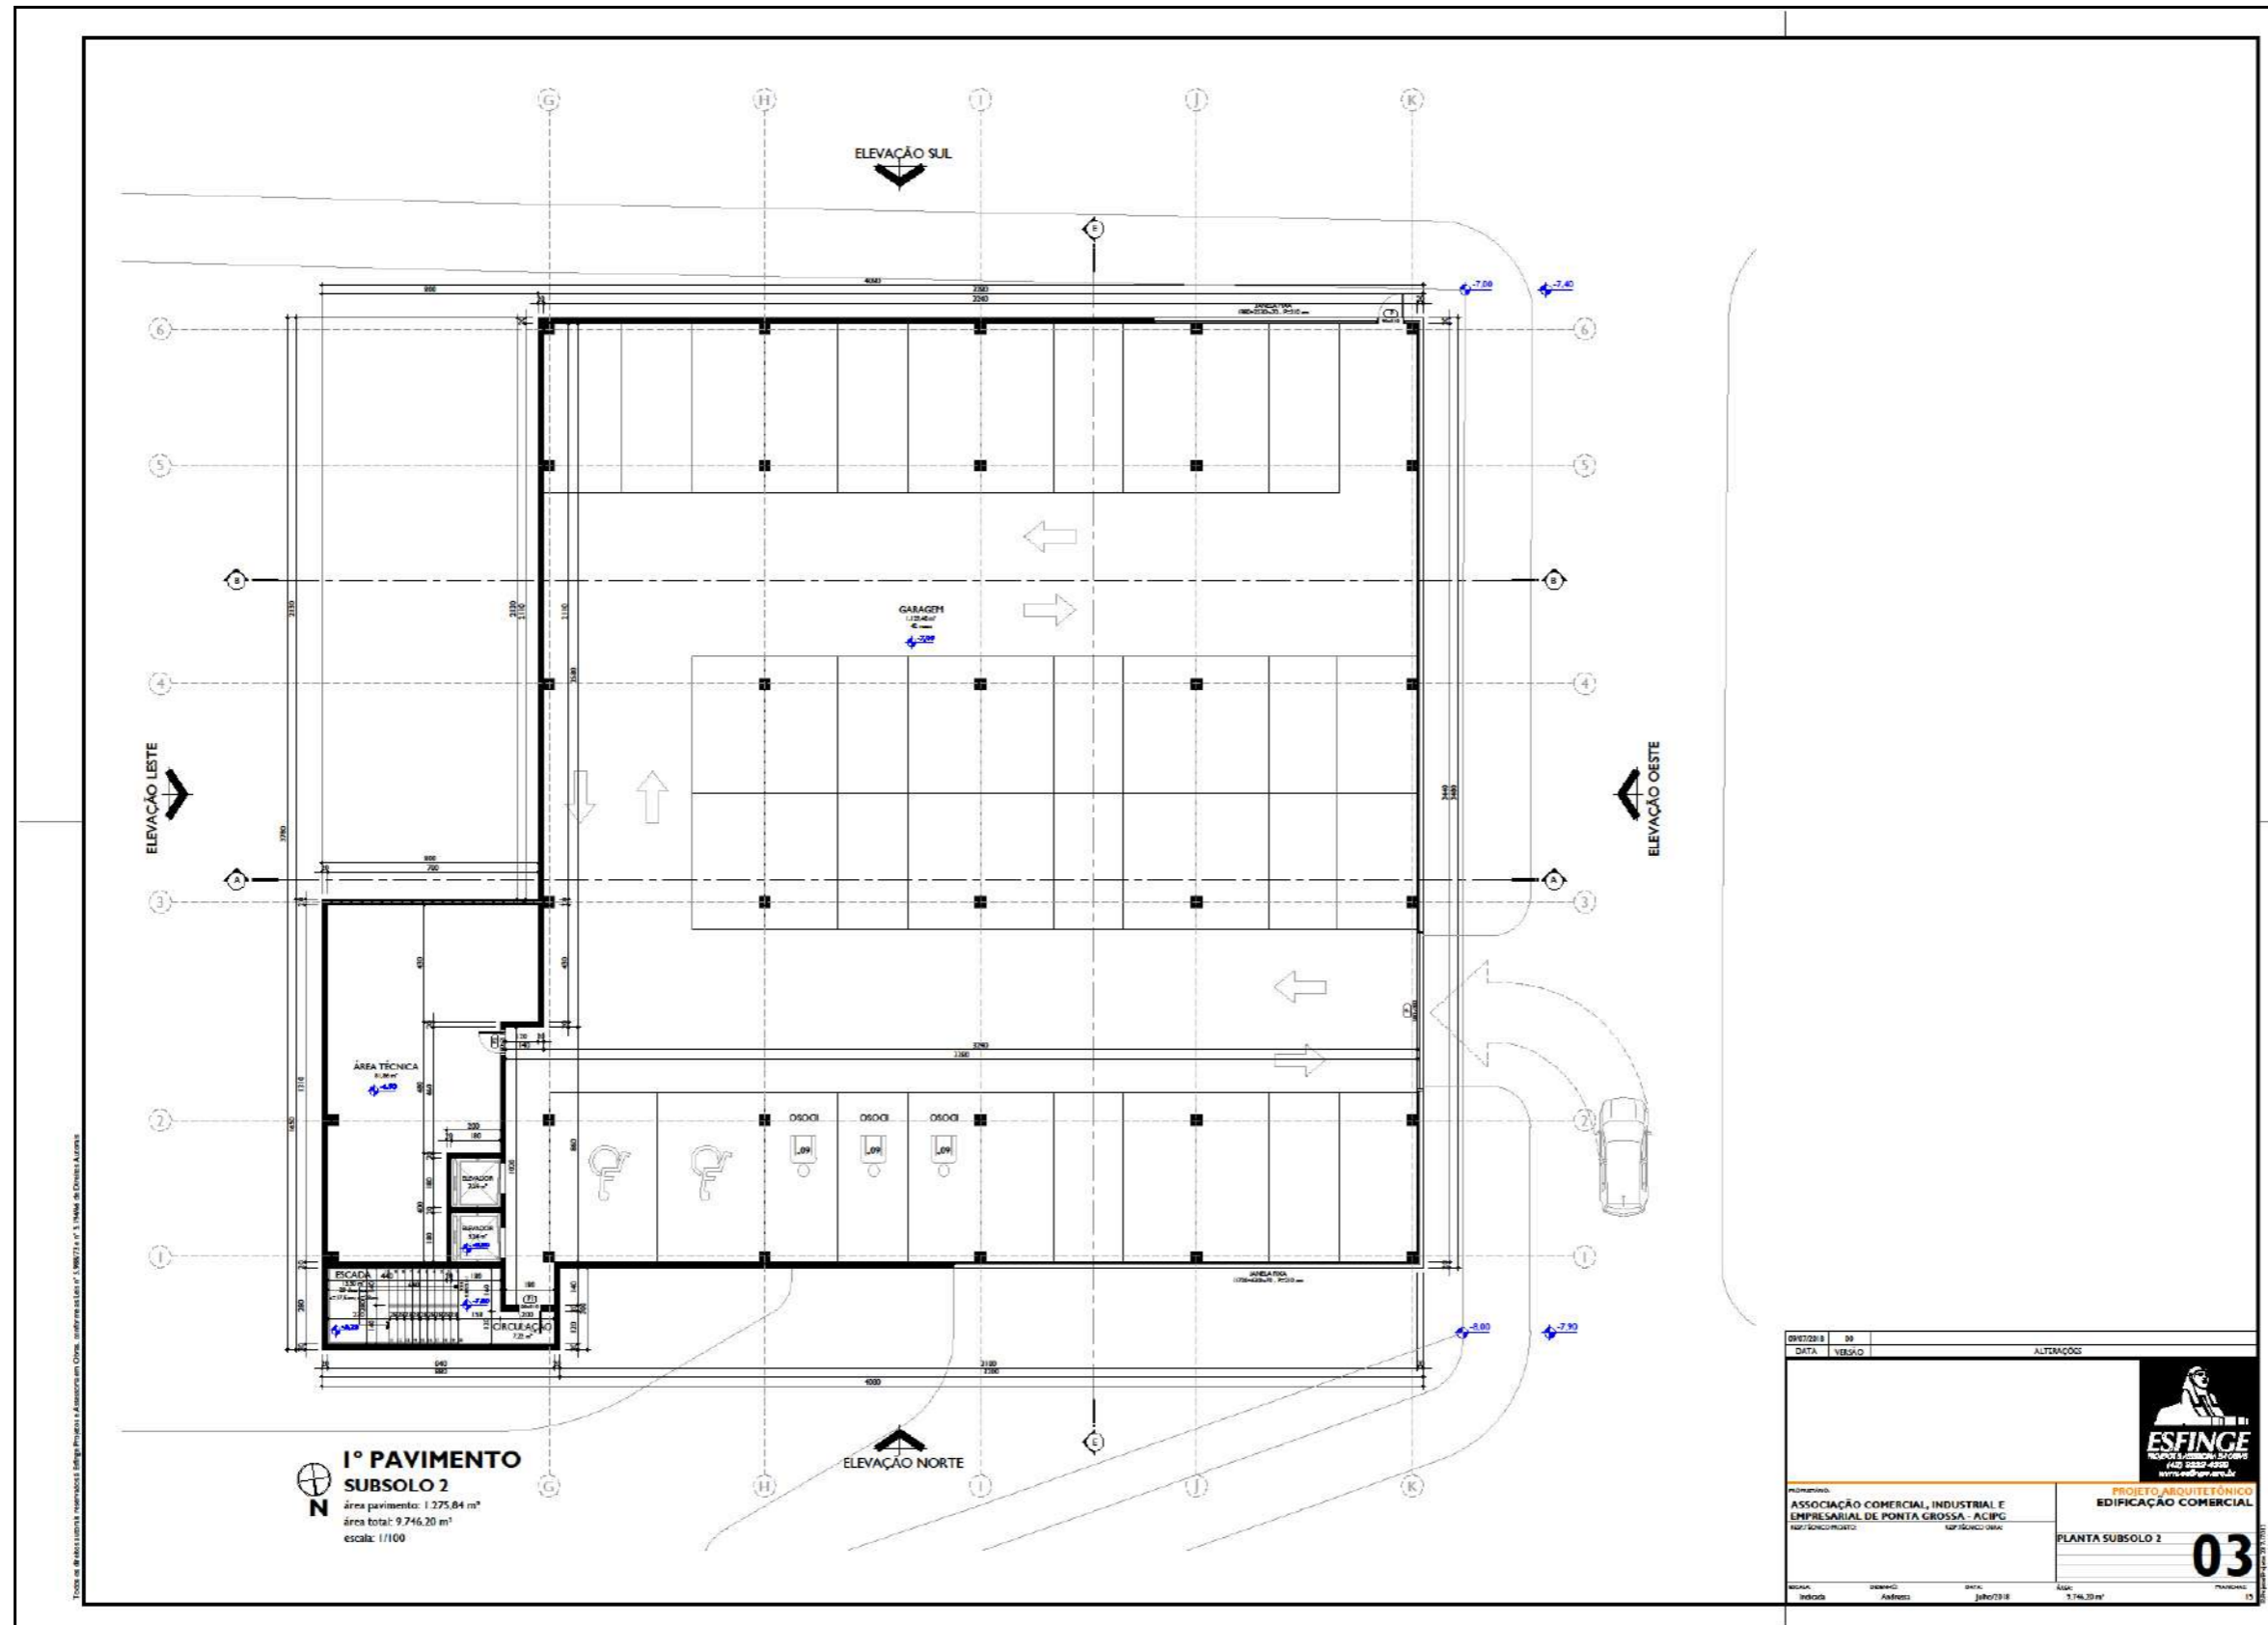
Planta subsolo 2. Fonte: Esfinge Arquitetura e Engenharia (2018).
